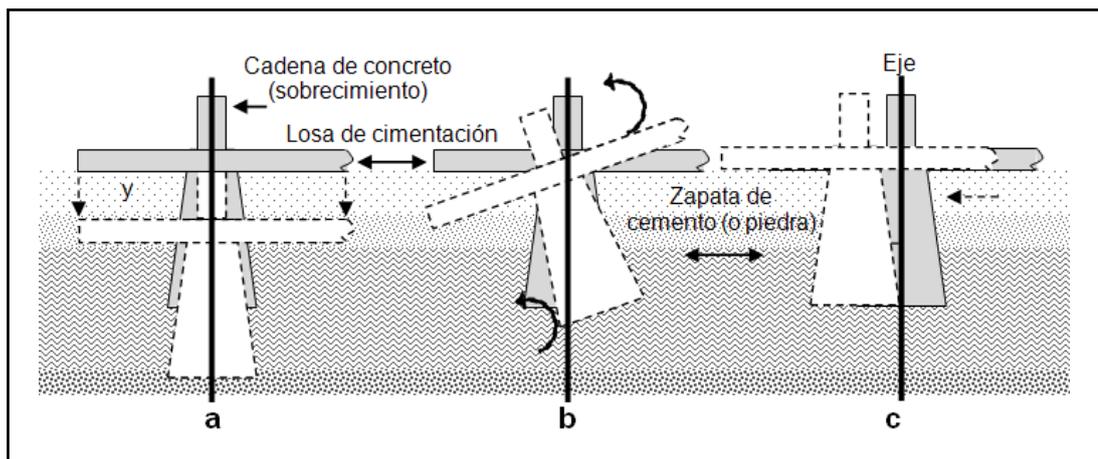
Efecto perjudicial en la cimentación durante el asentamiento debido a la mala elección del sitio: a) Falla por descenso; b) Falla por rotación o volcamiento; c) Falla por traslado.
